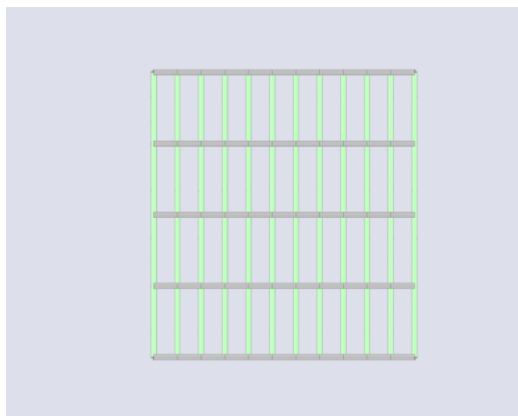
Modelagem tridimensional unifilar do pavimento inferior
